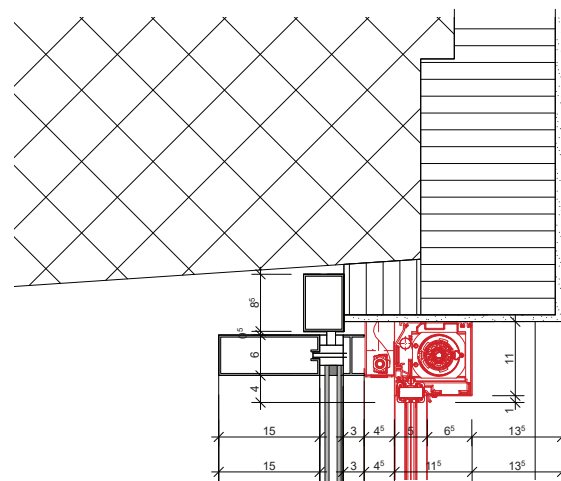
/ Sturz EG Süd-West-Fassade Kantine
